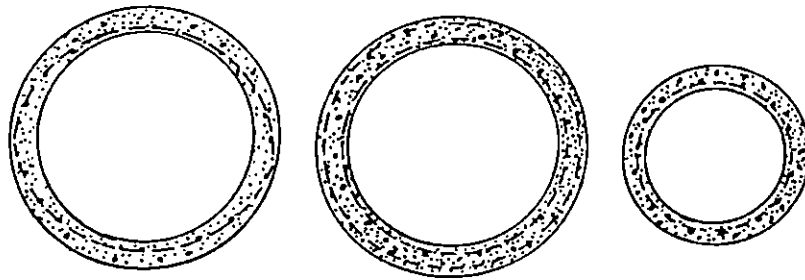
Sección Transversal de Tubos de Hormigón Armado para Alcantarillas
